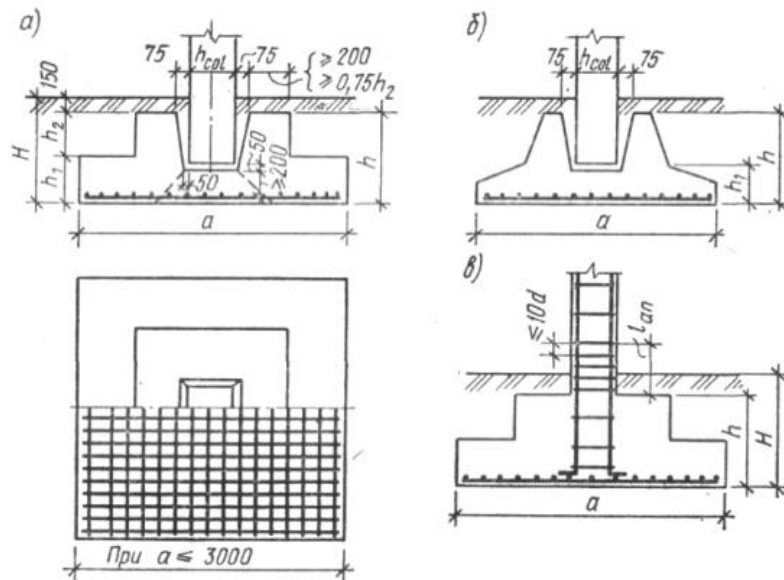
Отдельные центрально нагруженные фундаменты:
